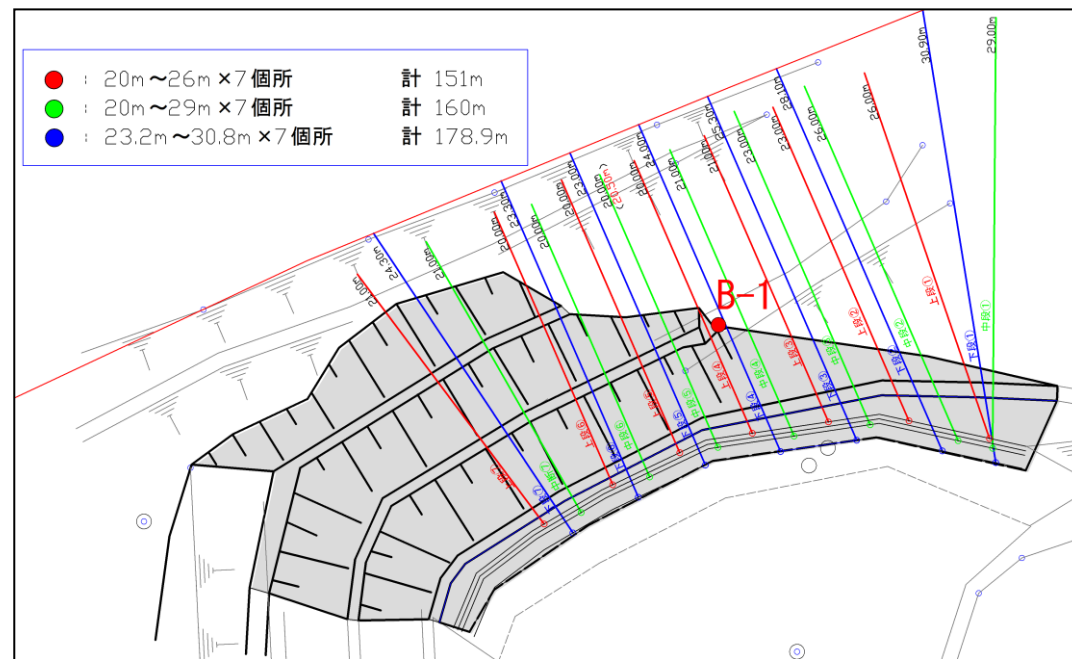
AB 地区境界部北側法面横ボーリング配置図
